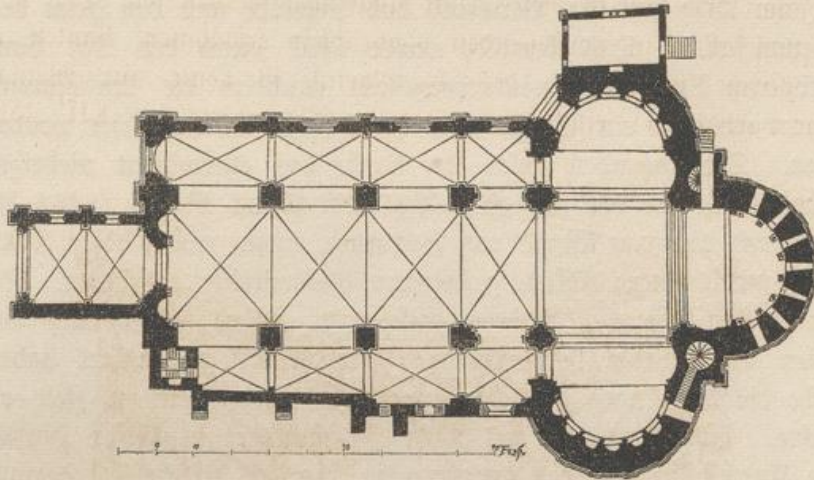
Grundriß der Kirche Groß St. Martin zu Köln.
